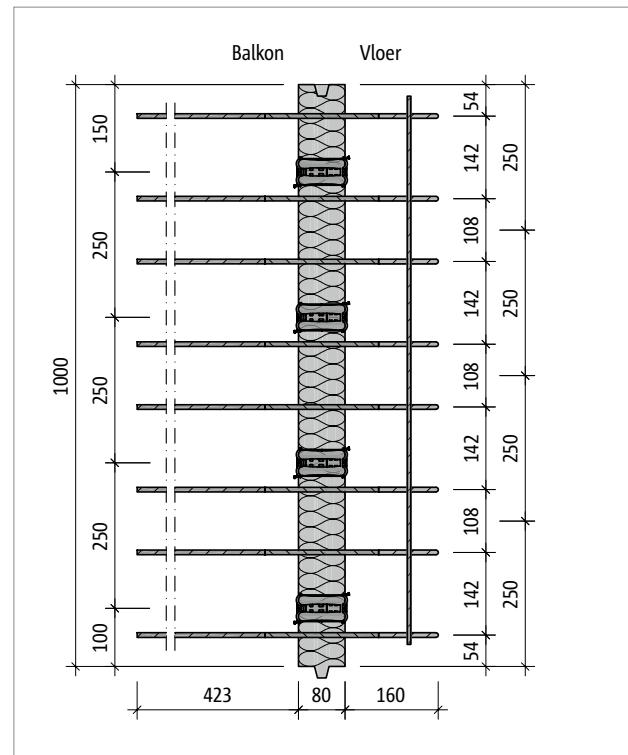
Schöck Isokorb® T type Q-E-V4: Doorsnede
